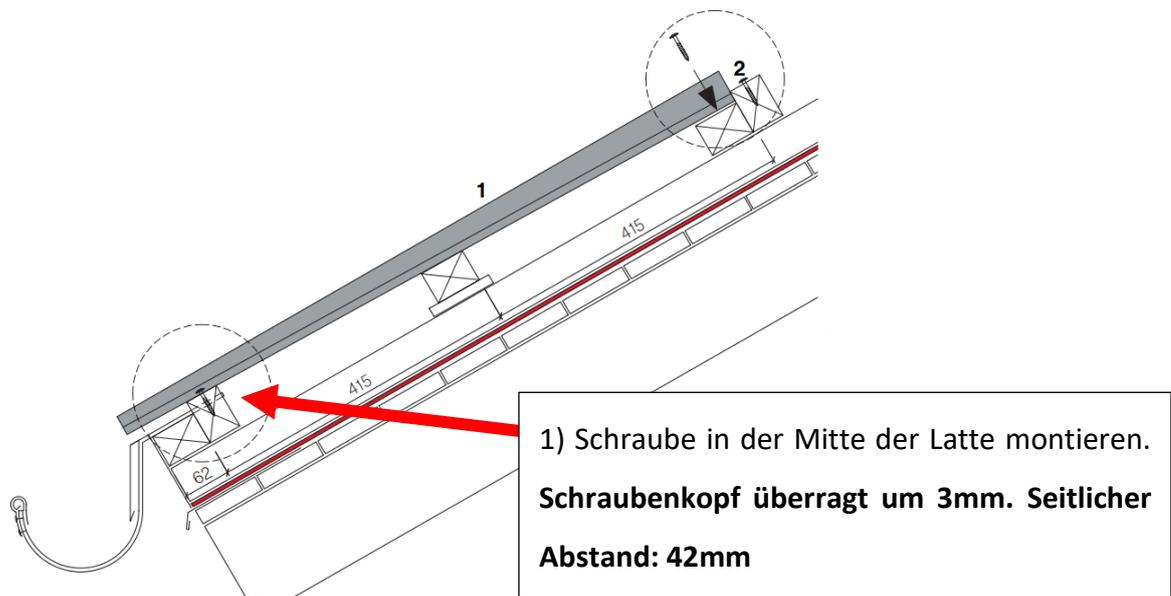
Schraube montieren (Quelle: Swisspearl Details Sunskin Roof Lap)
